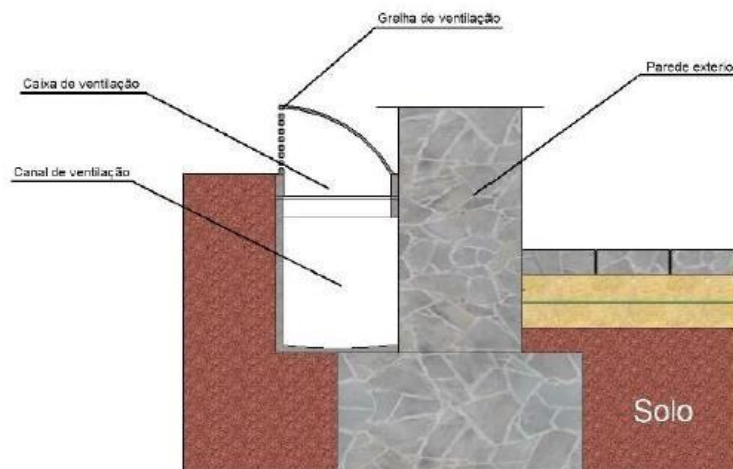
Corte construtivo do sistema de ventilação exterior com pormenor da grelha de ventilação [13]
